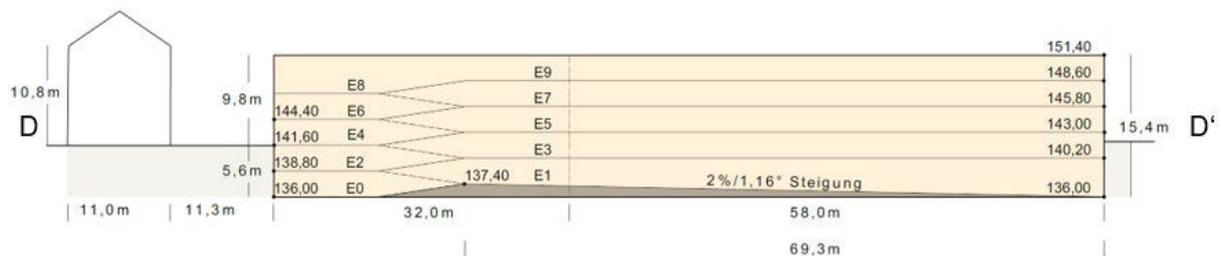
Alternative Erschließung – Systemschnitt Parkhaus D-D' (o.M.)
